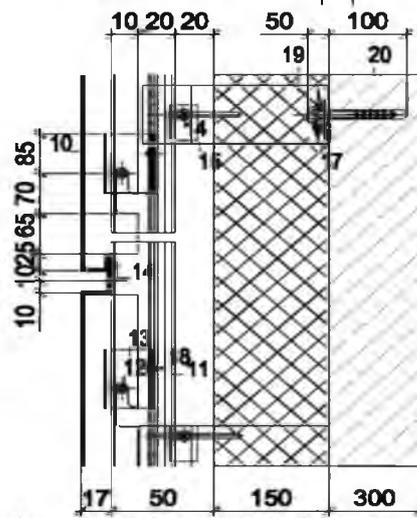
Вузол влаштування вентилязованого фасаду
